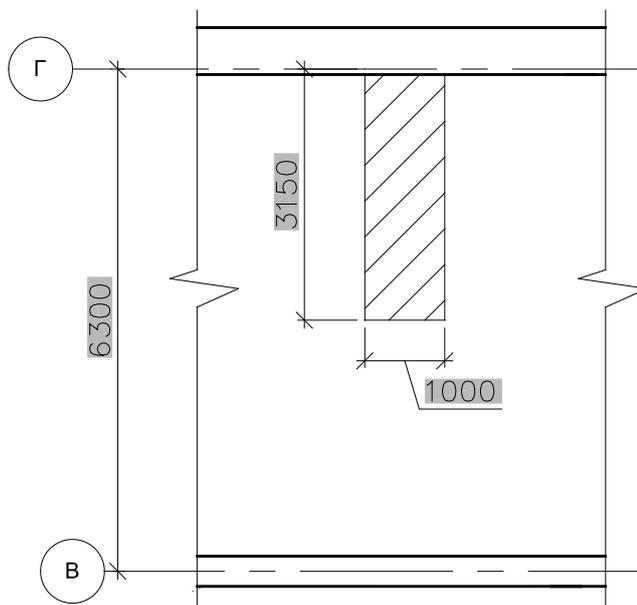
Грузовая площадь при расчёте фундамента наружной стены
